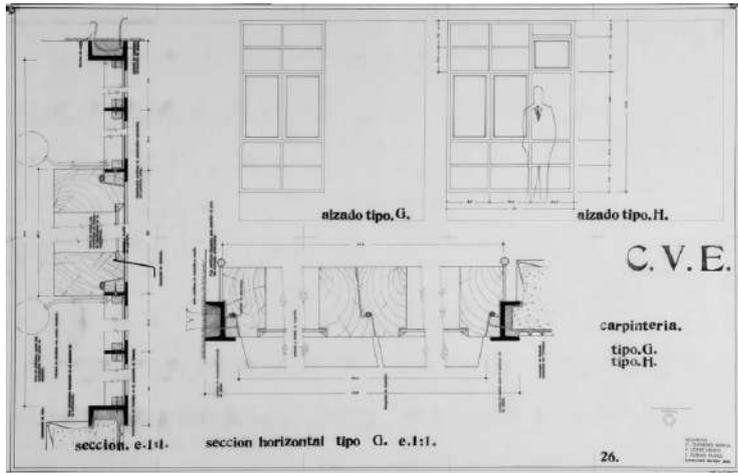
Plano de detalles constructivos para las mamparas de las fachadas de las viviendas experimentales del INV realizados por el grupo LIGS. Fondo Arxiu Històric COAC.
